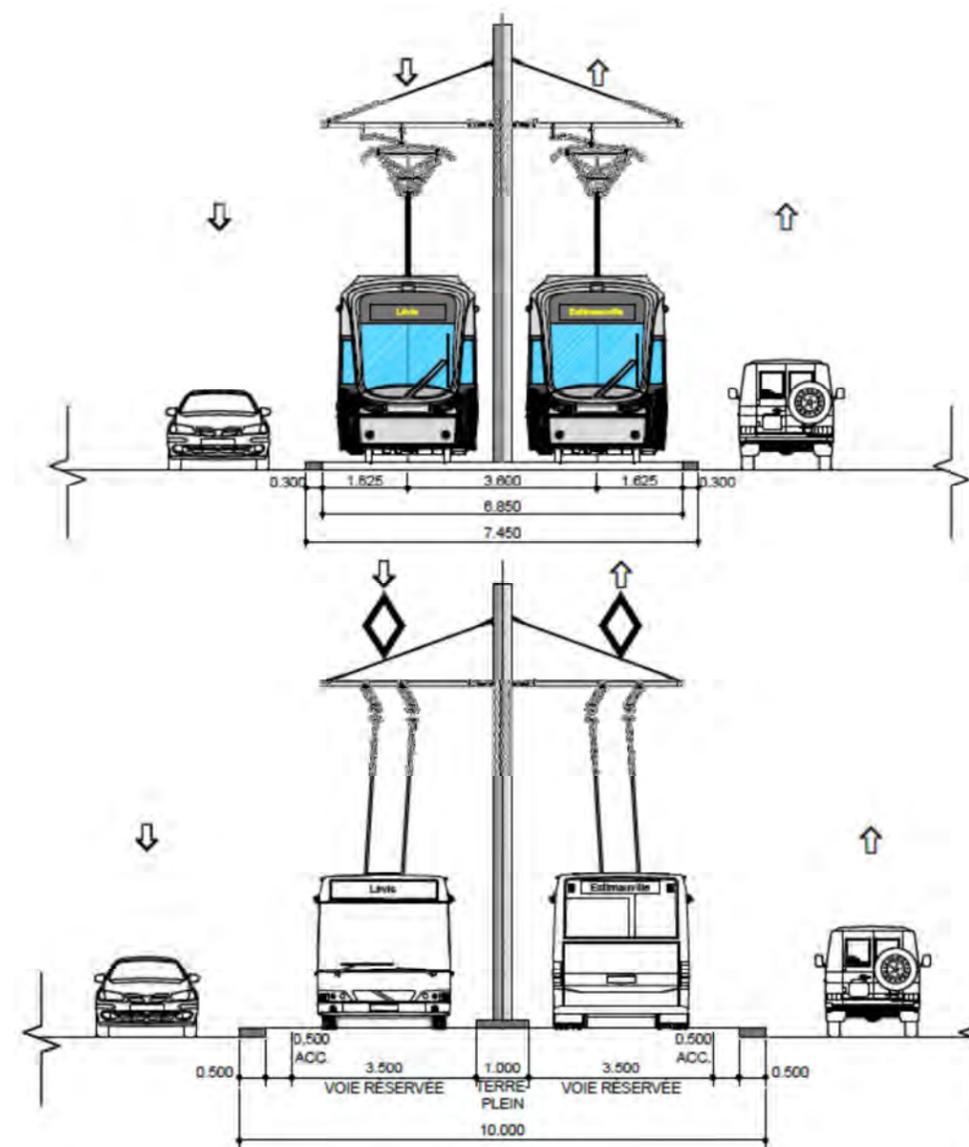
Coupe type 09 de 15 - SRB - Site propre standard - Insertion axiale - Terre-plein central
